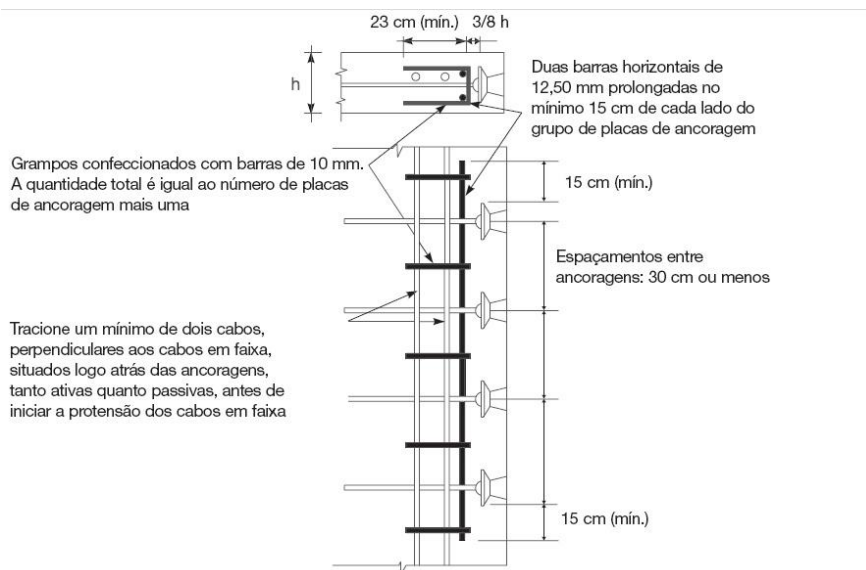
Detalhe genérico das armaduras de fretagem da laje. Fonte: Cauduro (2002)
